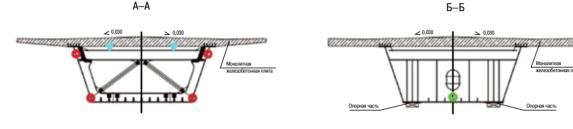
Расстановка датчиков на сталежелезобетонном пролетном строении
